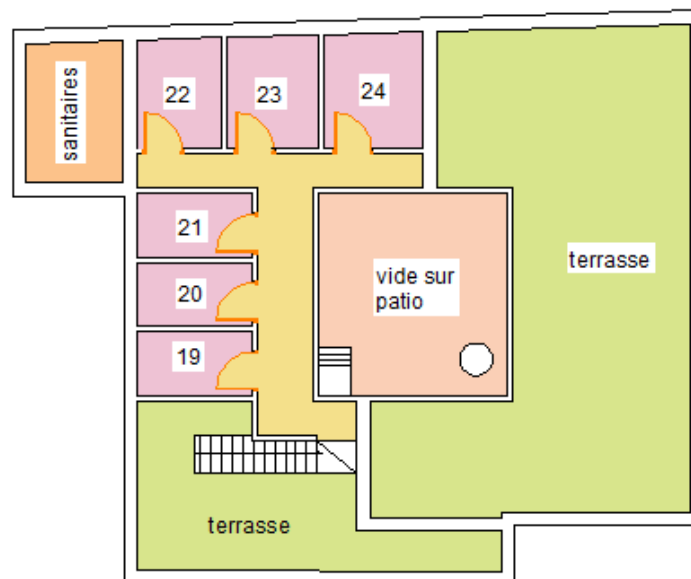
plan de 2eme étage de fondouk Ben Mansour
